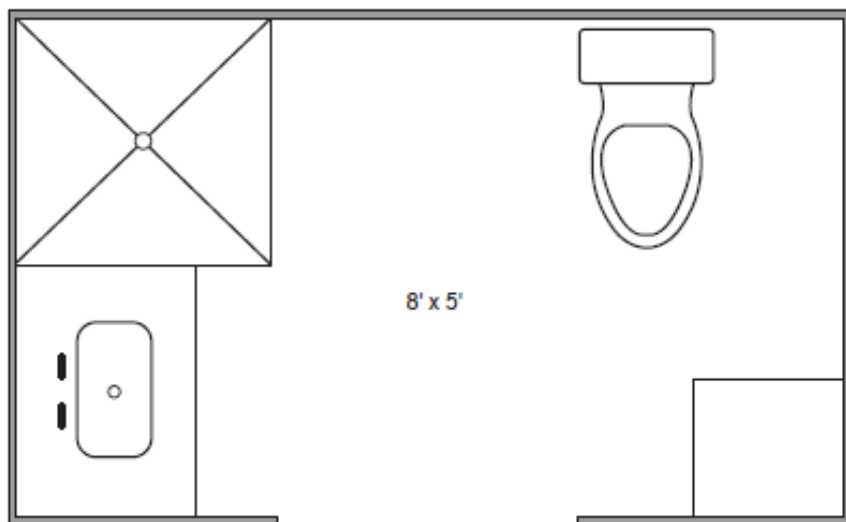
Distribución de baño común en una tiny house 2.40 x 1.50 m. Fuente: *Tiny house designing, building and living*, 2017
